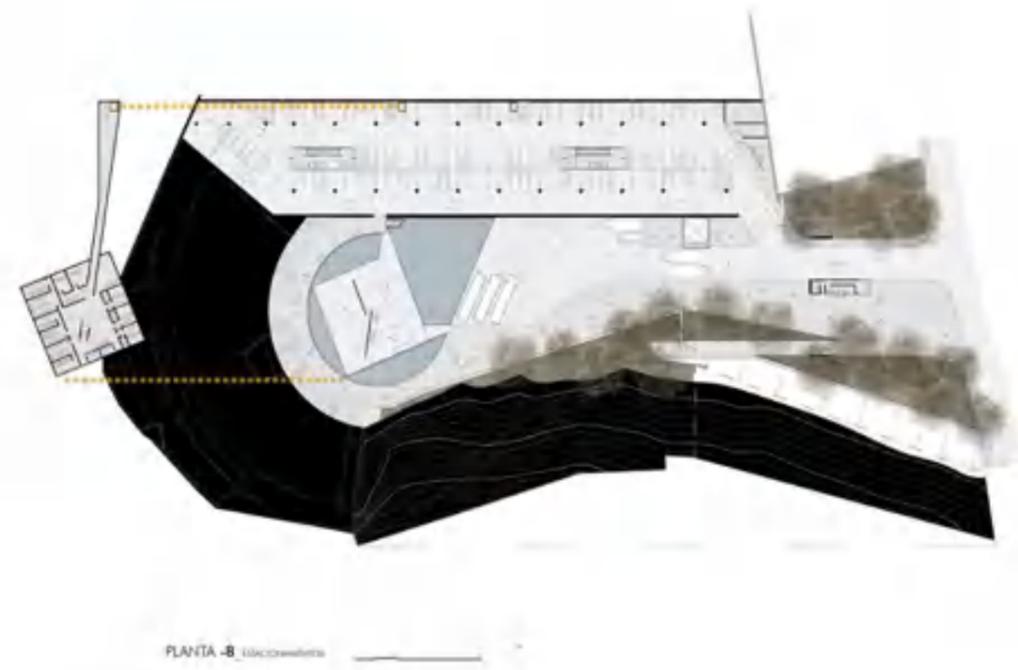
Planta Nivel -8. FONTE: *Archdaily*.
